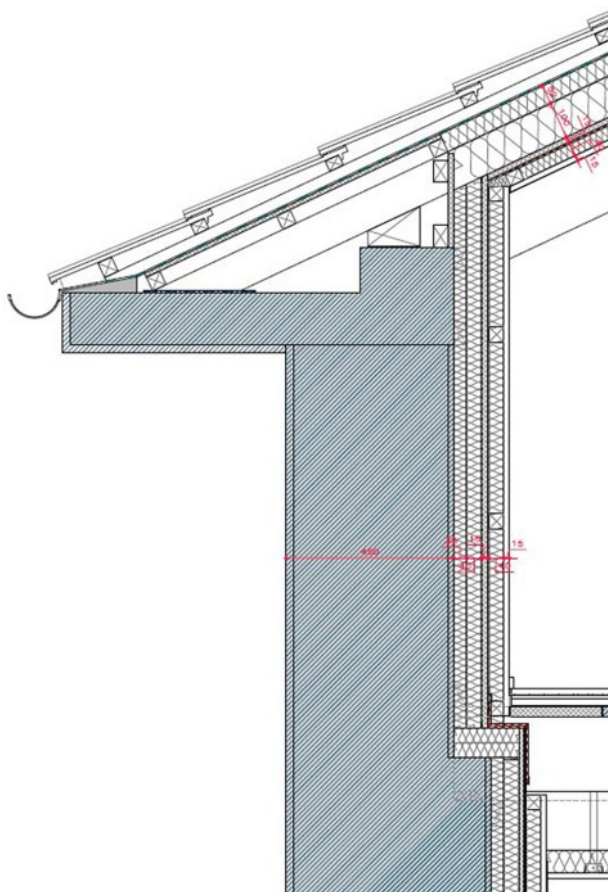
Detalle Constructivo: Encuentro fachada-cubierta.
